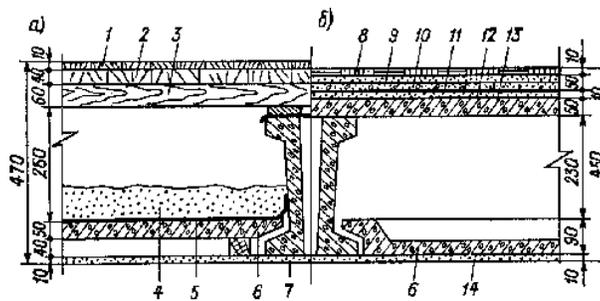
Перекрытие по железобетонным балкам швеллерного сечения
